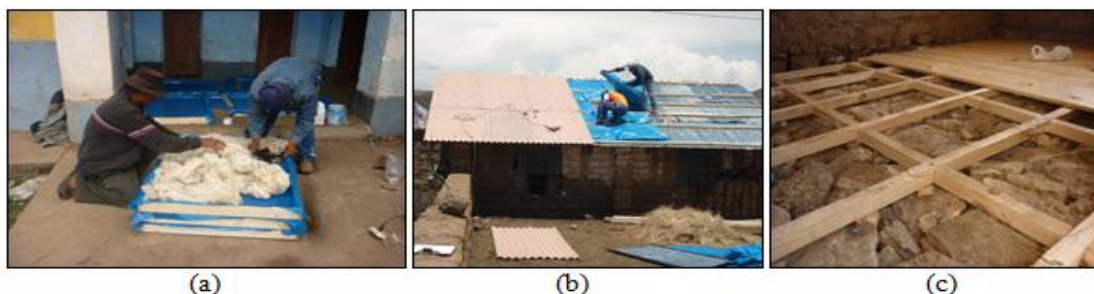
(a) Elaboración de colchón aislador con lana de oveja. (b) Aislamiento de techo. (c) Aislamiento de piso.
